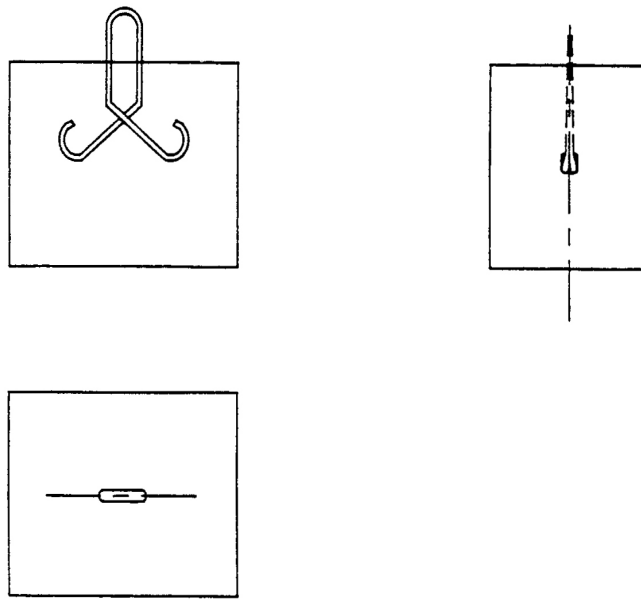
浮碼頭錨碇混凝土方塊設計例
